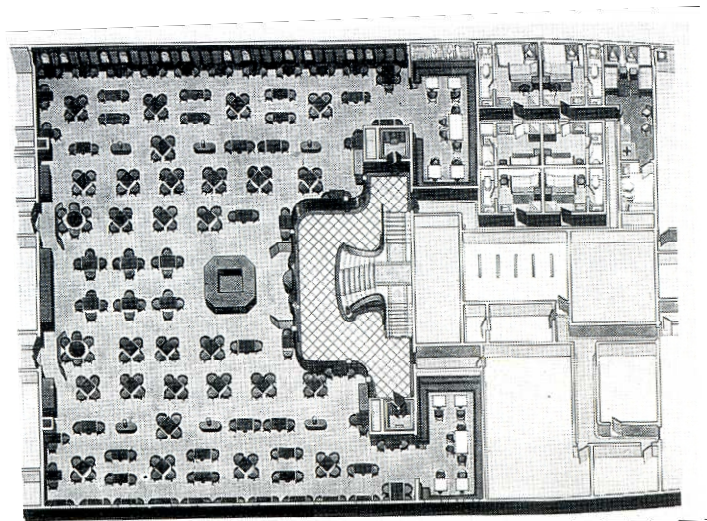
Gino ed Adolfo Coppedè, sistemazione di un salone, planimetria
